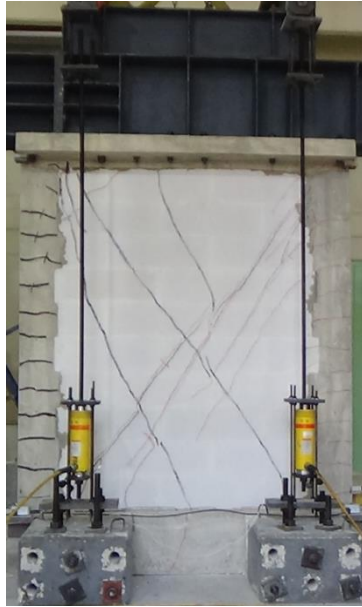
Grietas diagonales al alcanzar la carga maxima del muro M-1.23-7.2
